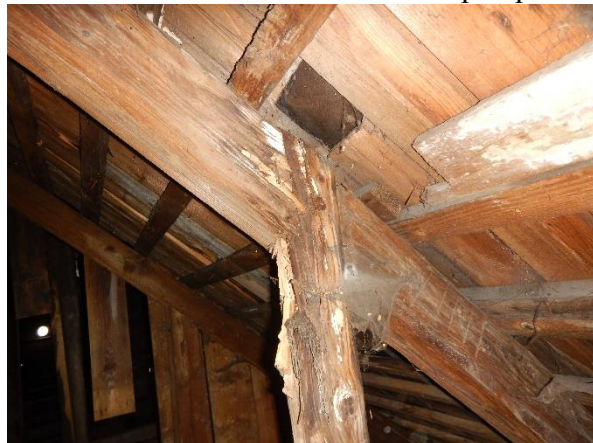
a 10 - sonda NV 4 – celkový pohled a detail,
